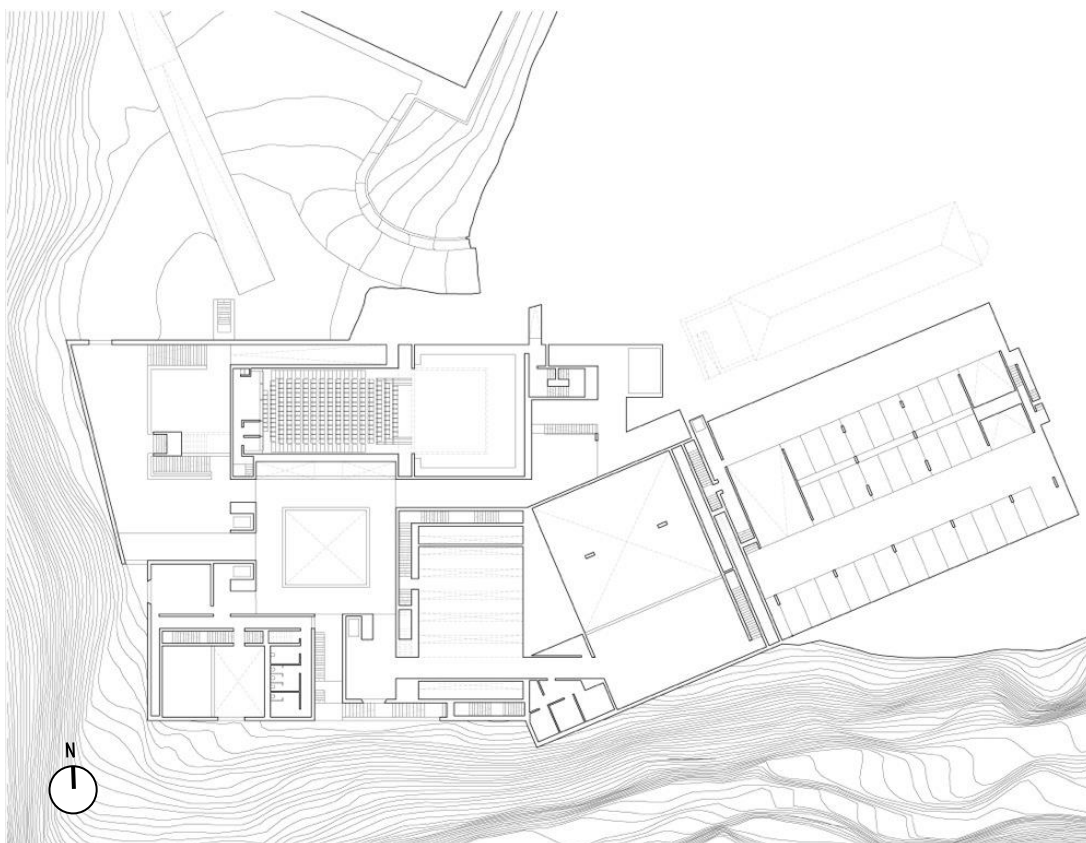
DAVID, Paulo, *Casa das Mudas*, Madeira, 2002/04. Planta do Piso -1. Desenho sem escala.
